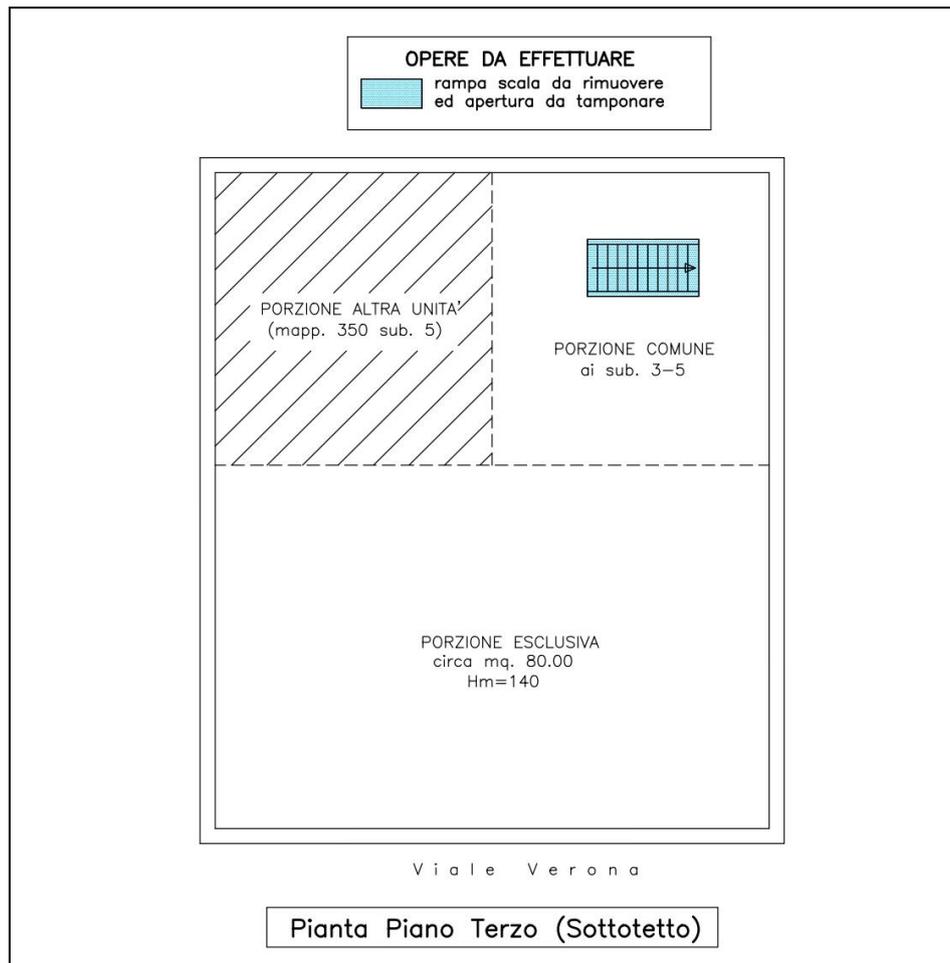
b. Planimetrie immobile – Piano Terzo (Sottotetto).
